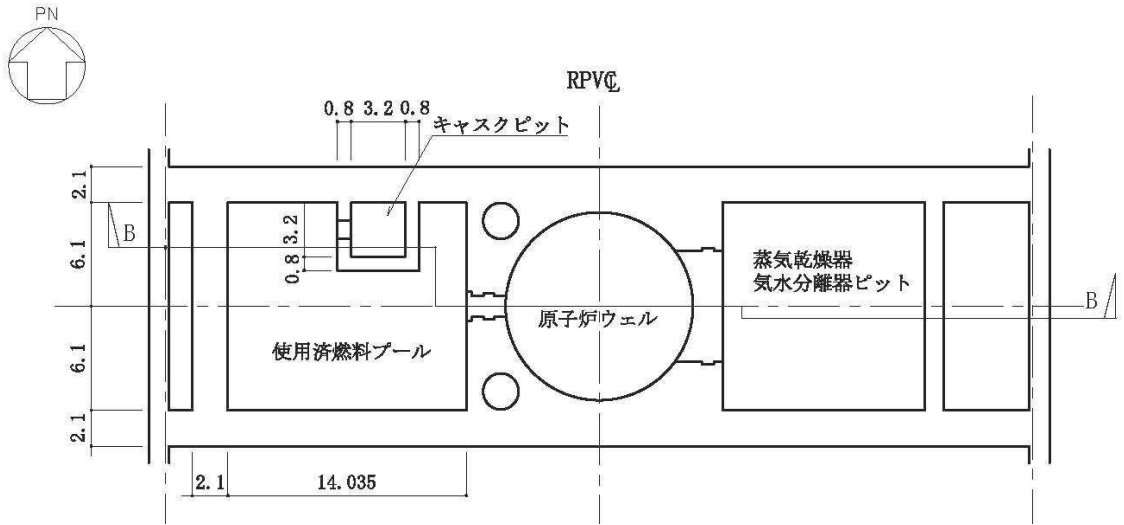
使用済燃料プール及びキャスクピットを含む原子炉建屋の概略平面図
